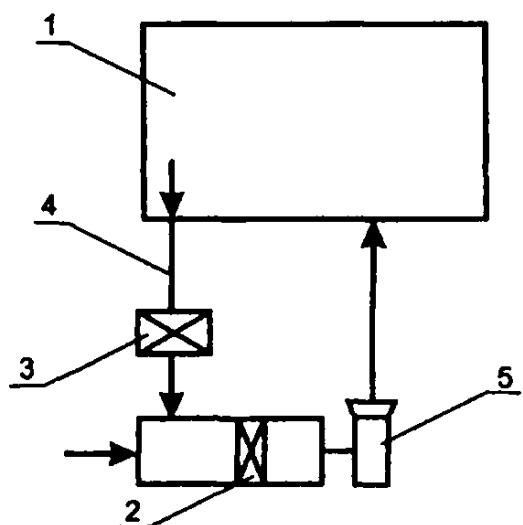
Схема приточной вентиляции или кондиционирования с дополнительным воздухонагревателем, установленным в рециркуляционном воздуховоде: 1 – обслуживаемое помещение; 2 – основной воздухонагреватель; 3 – дополнительный воздухонагреватель; 4 – рециркуляционный воздуховод; 5 – вентилятор
